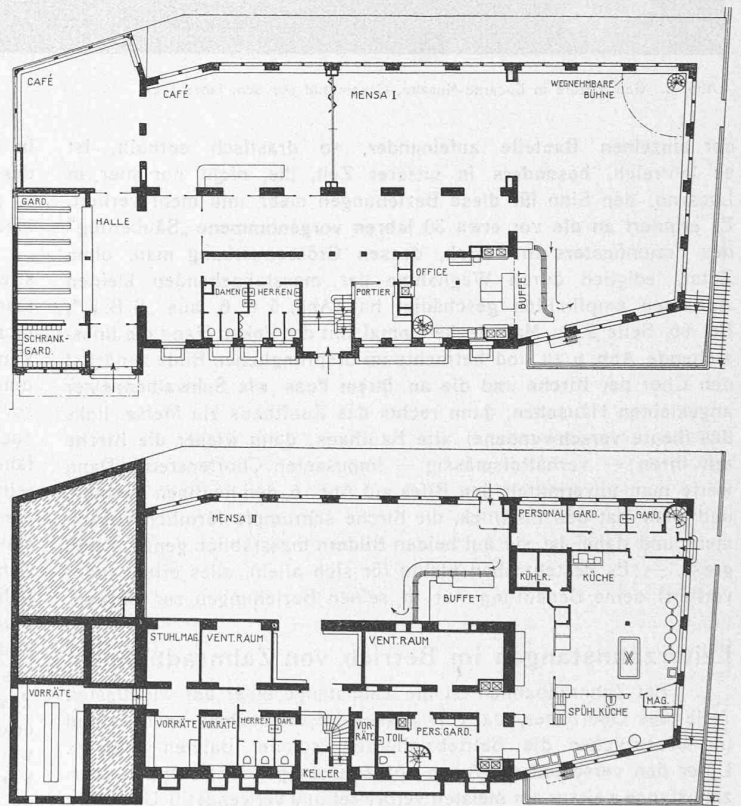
und 2. Grundrisse (1 : 500) des Studentenheims an der E. T. H. Umbau einer ehemaligen Buchdruckerei durch Arch. O. Pileghard, Zürich.
